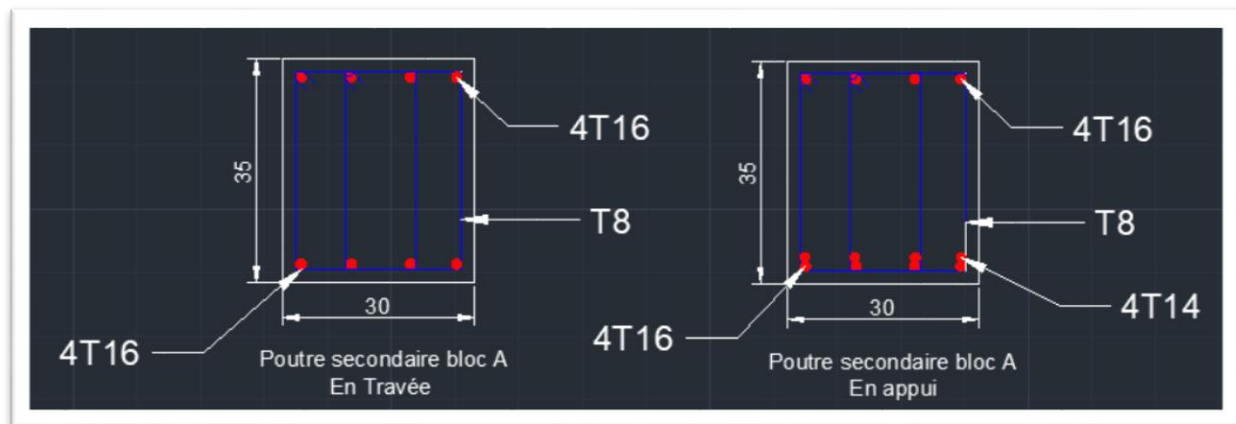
Schéma du ferrailage de la poutre secondaire du bloc A
